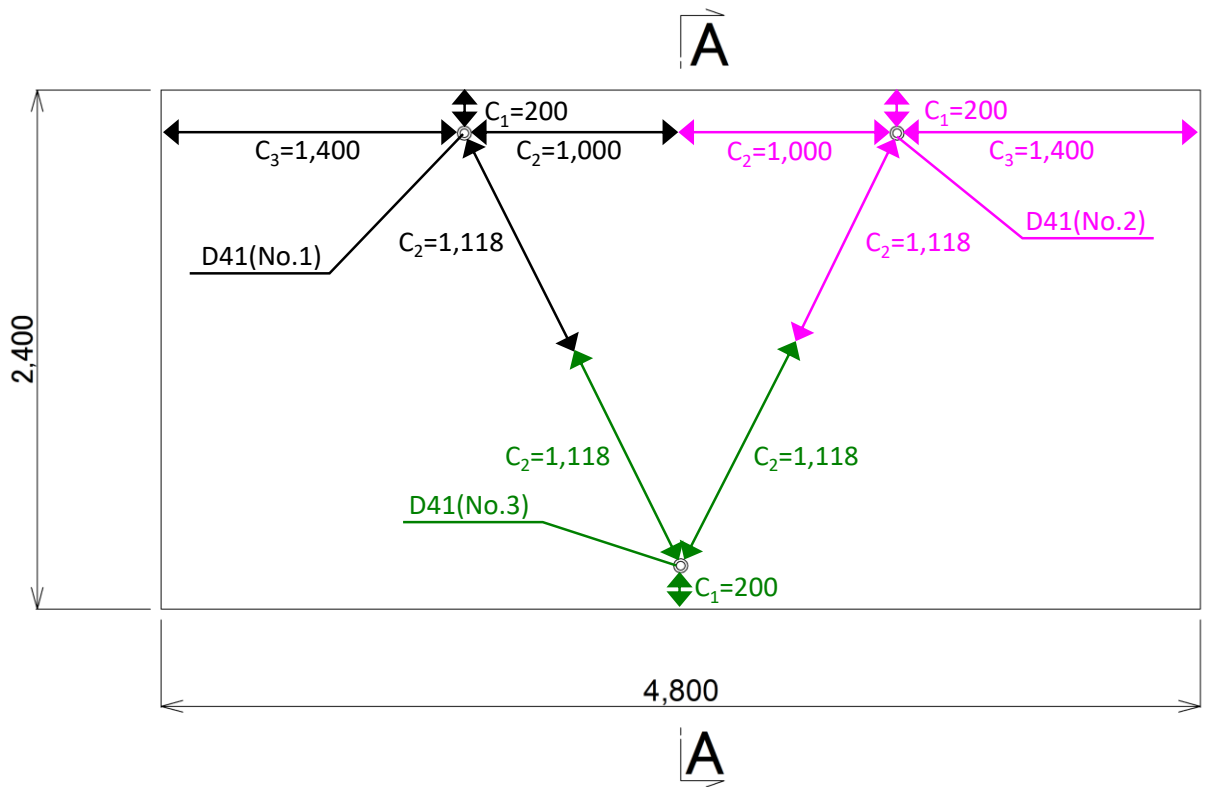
(5) 実験体の構造図* (供試体②の平面図)
